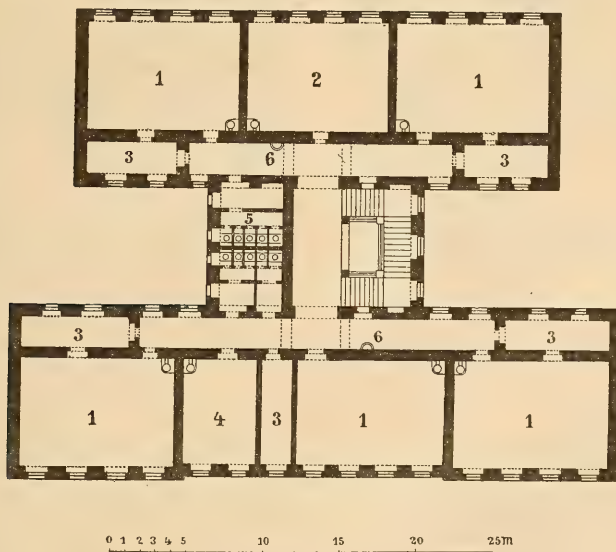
Wie Fig. 24. Grundriss des 1. Stockwerkes nach K. Hintraeger. 1 Lehrzimmer. 2 Zimmer für weibl. Handarbeiten. 3 Kleiderablage. 4 Konferenzzimmer. 5 Abtritte. 6 Wasserleitungsausfluss.
